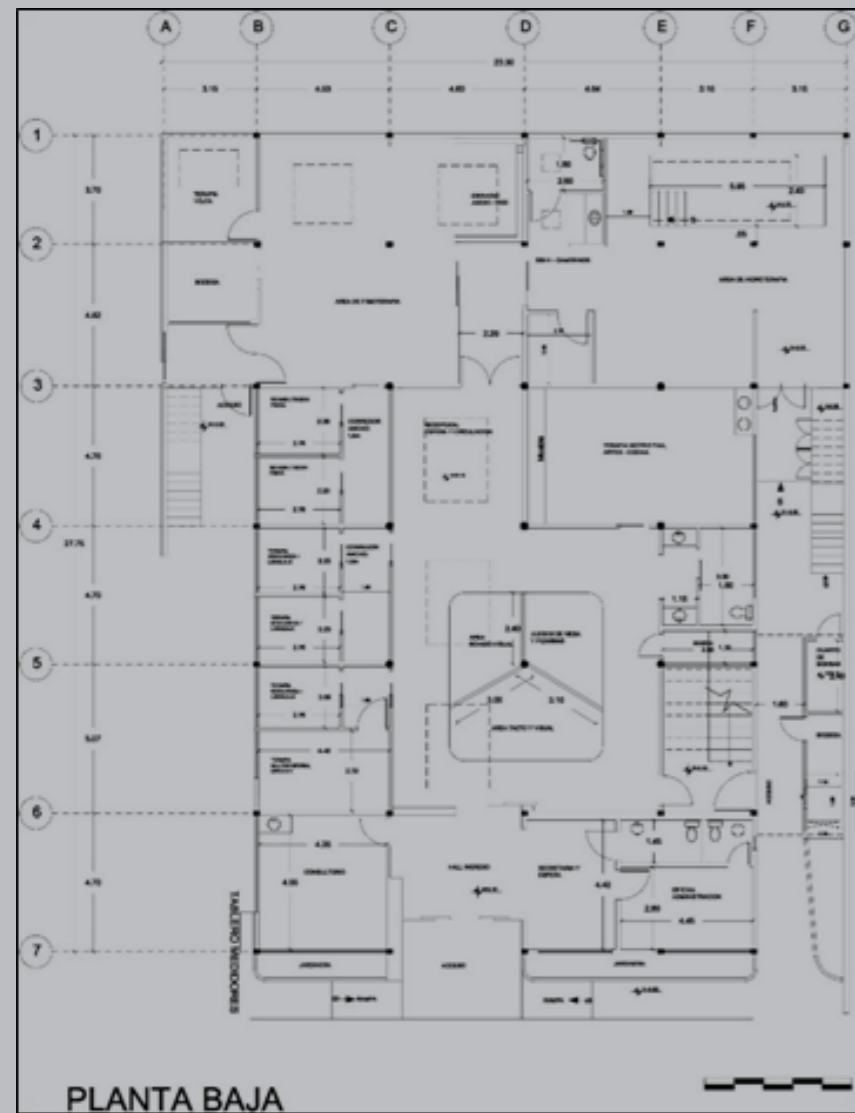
Planta baja Fundación Amigos del Ecuador.
